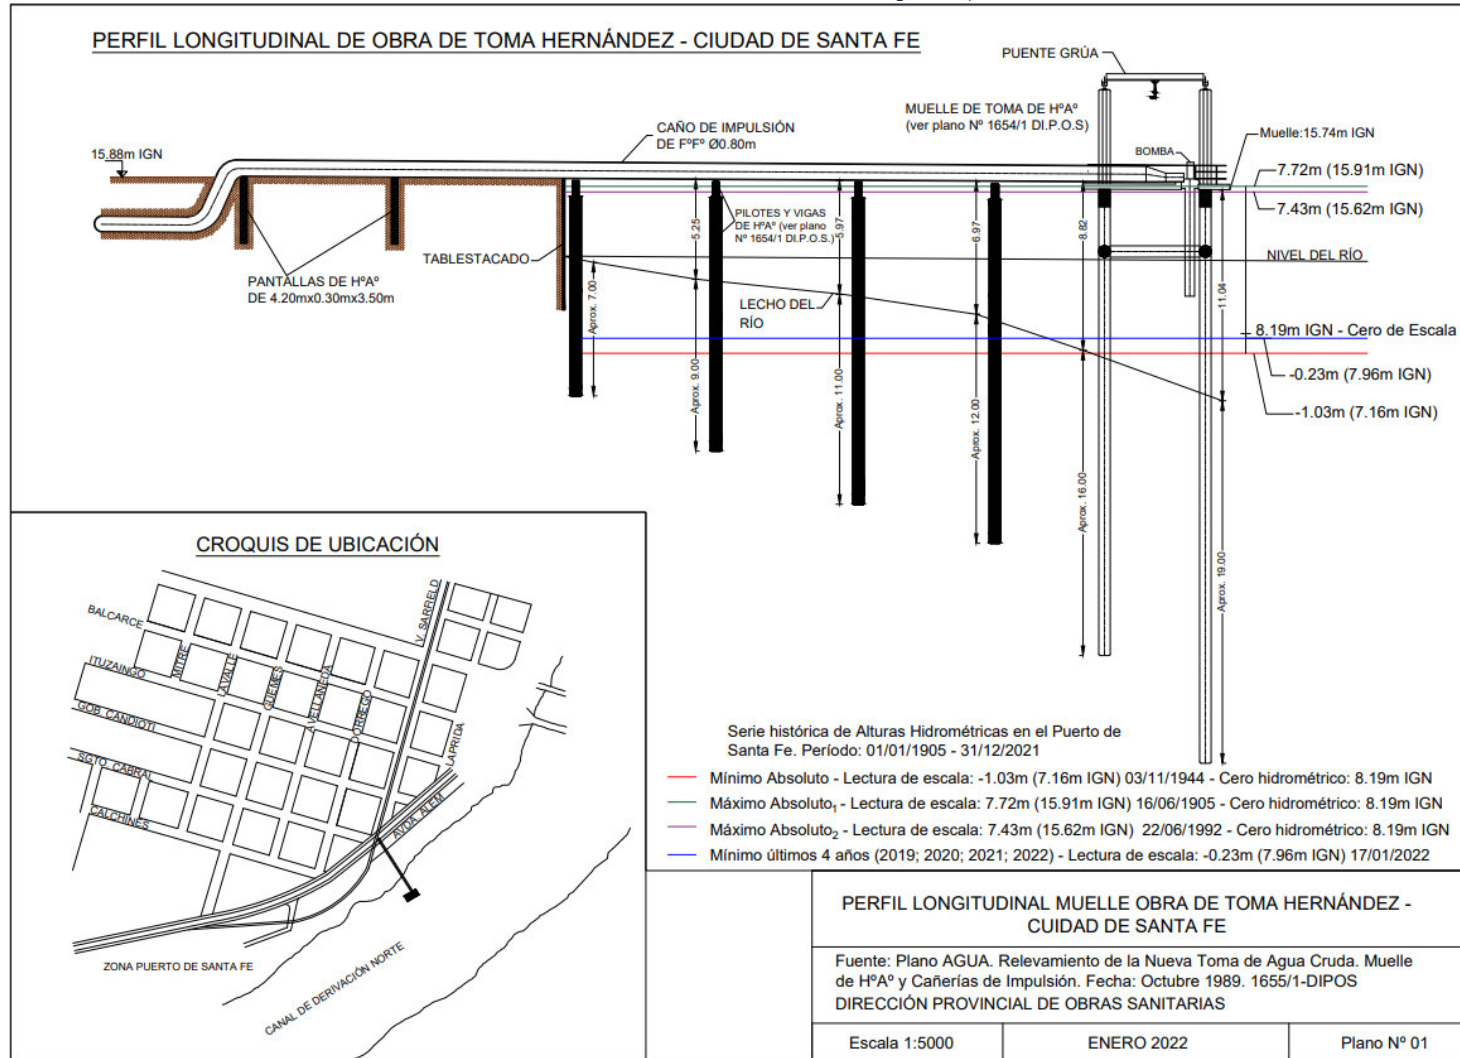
Planimetría y perfil longitudinal de la Toma Hernández con cotas de referencia – Santa Fe
